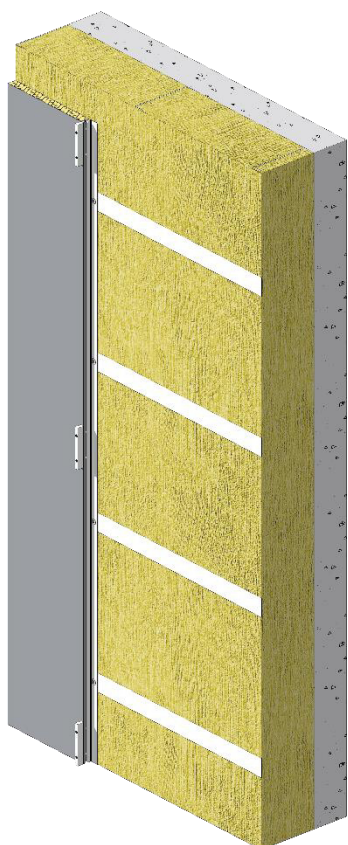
Principe d'emboîtement du profil joint debout entre les panneaux Myral
